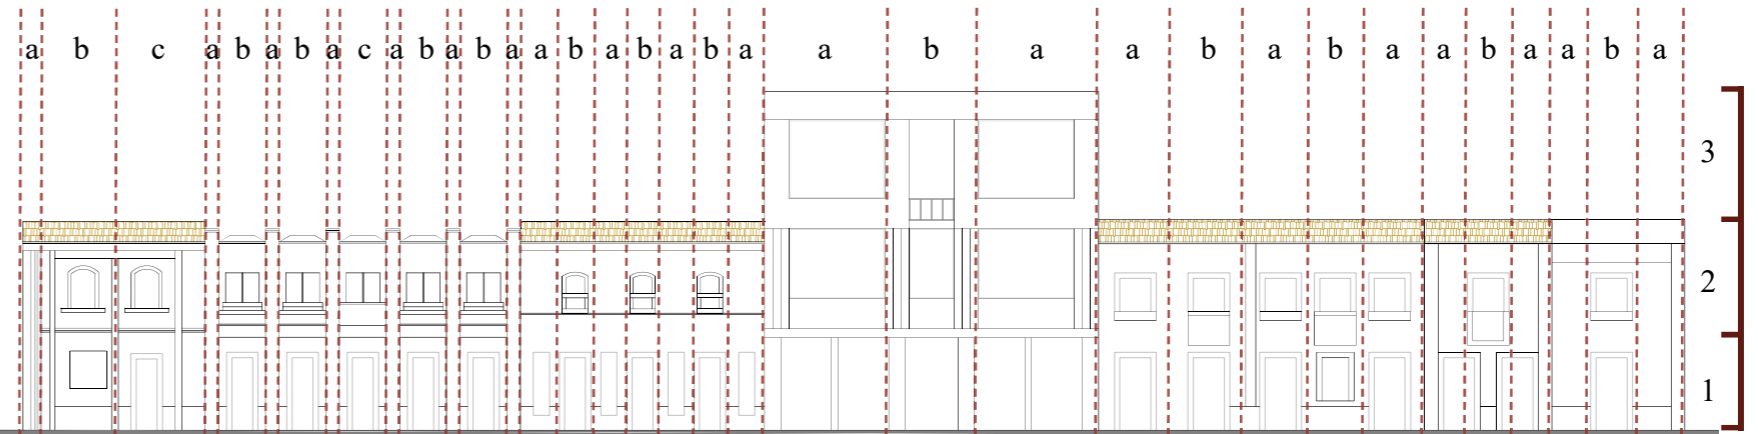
Análisis fachada oeste, tramo 1 calle Rocafuerte.
